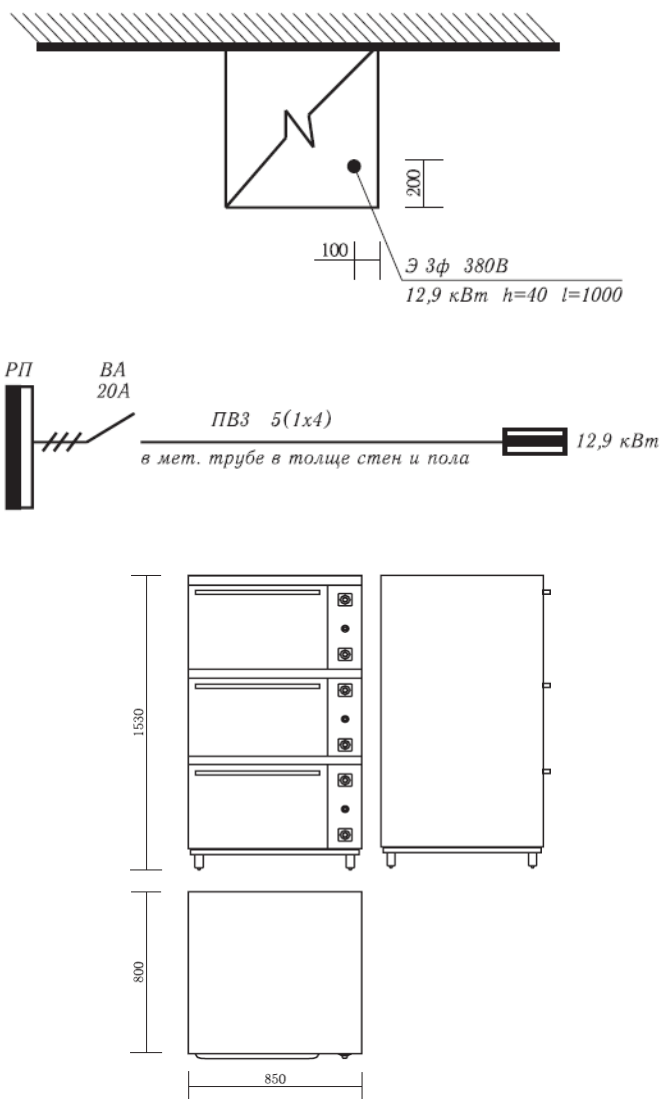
Схема подключения и габаритные размеры жарочного шкафа RADA ШЖЭ-903
